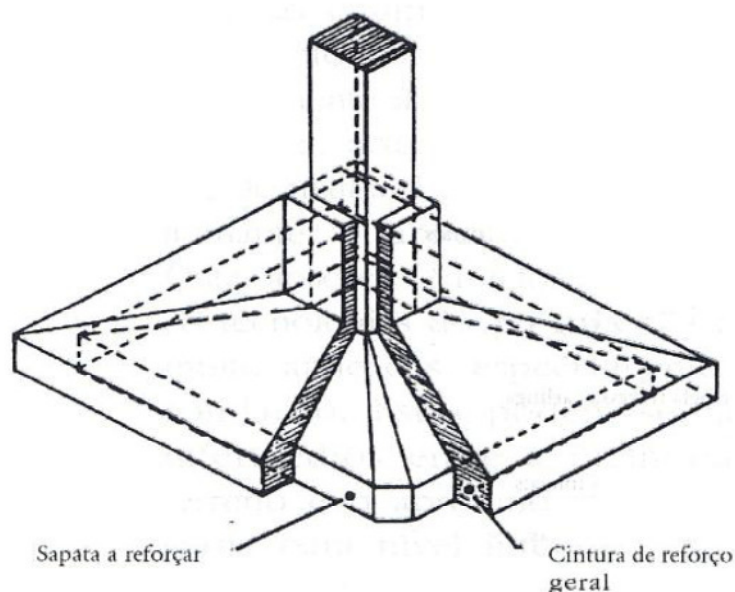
Reforço de sapata por cinta de concreto armado (Coelho, 1996)
